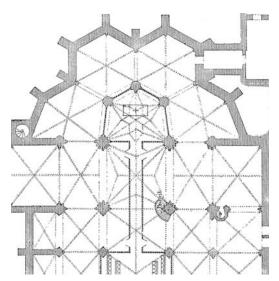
Pamplona. Catedral, planta del ábside y crucero (Street [1865] 1926)
